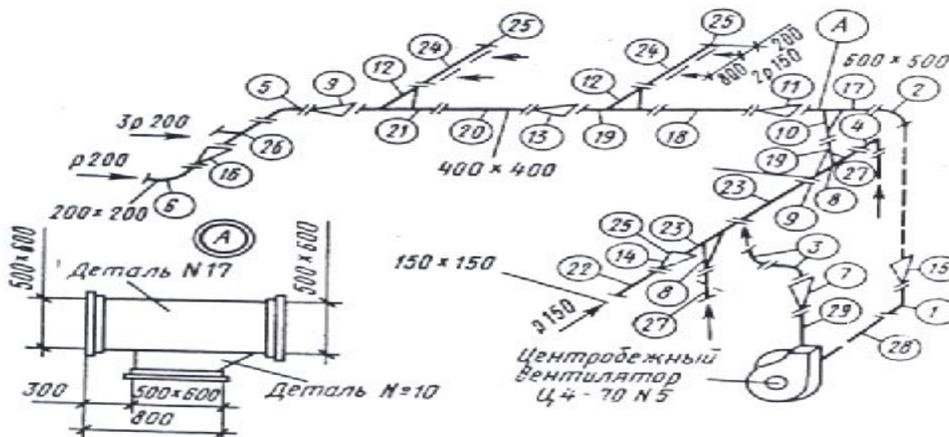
Монтажный чертёж системы вентиляции с прямоугольными воздуховодами из унифицированных деталей /5, с. 53/
